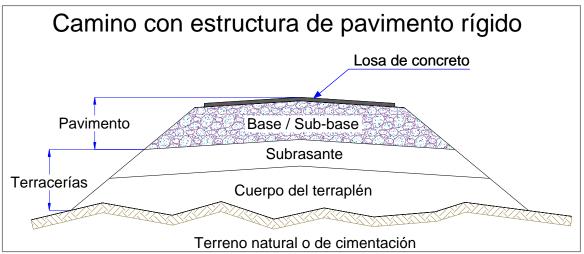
Camino con estructura de pavimento rígido, Ilustración, 2017
